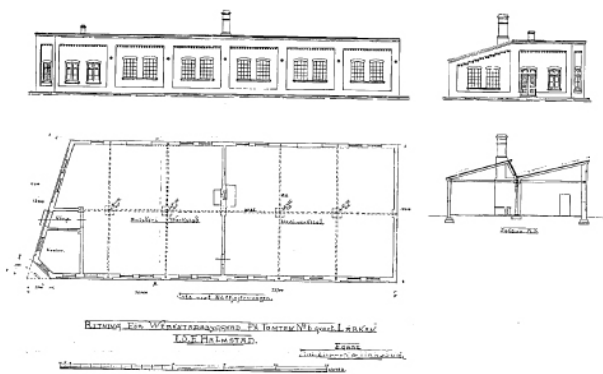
Snickeriverkstaden Andersson & Hansson år 1914, ursprungligt utförande (1920) med fasad och planritningar.
